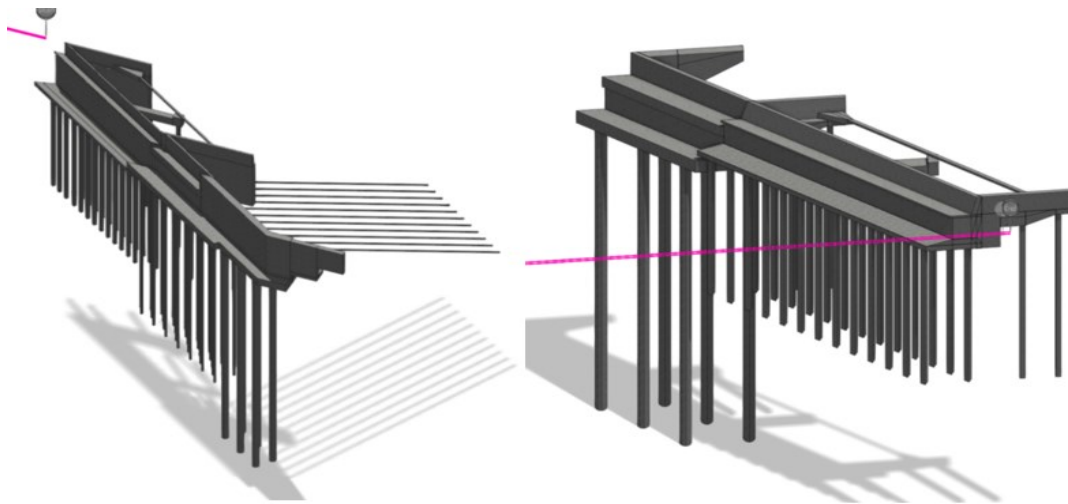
Rispettivamente Spalla Padova e Venezia impalcato Nord
